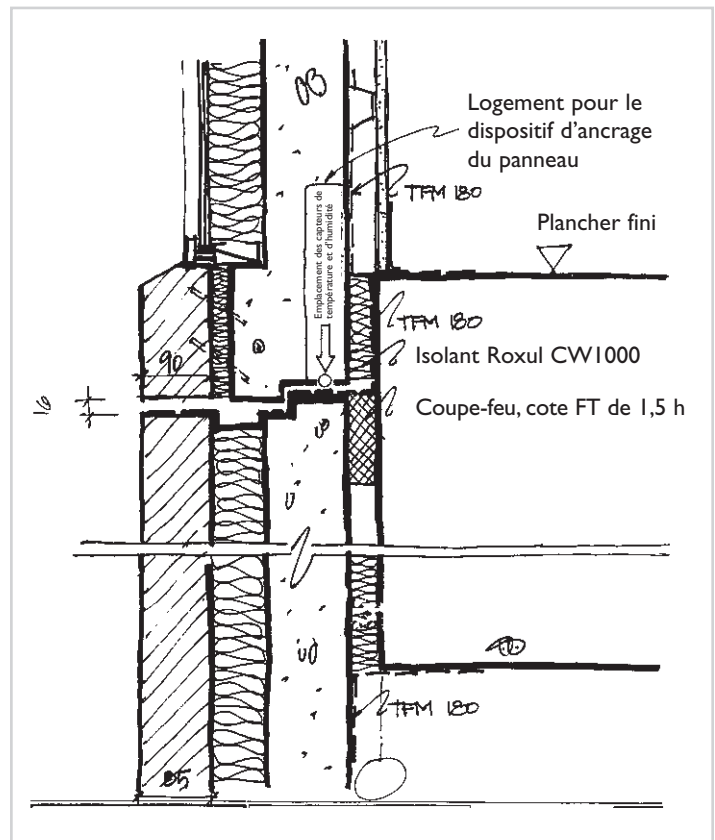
Détail de construction du mur – coupe à l'emplacement d'un joint horizontal entre deux panneaux
